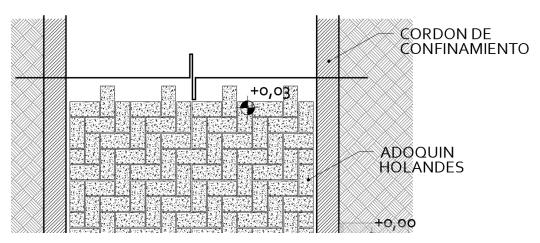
Detalle en planta pavimento articulado intertrabado
